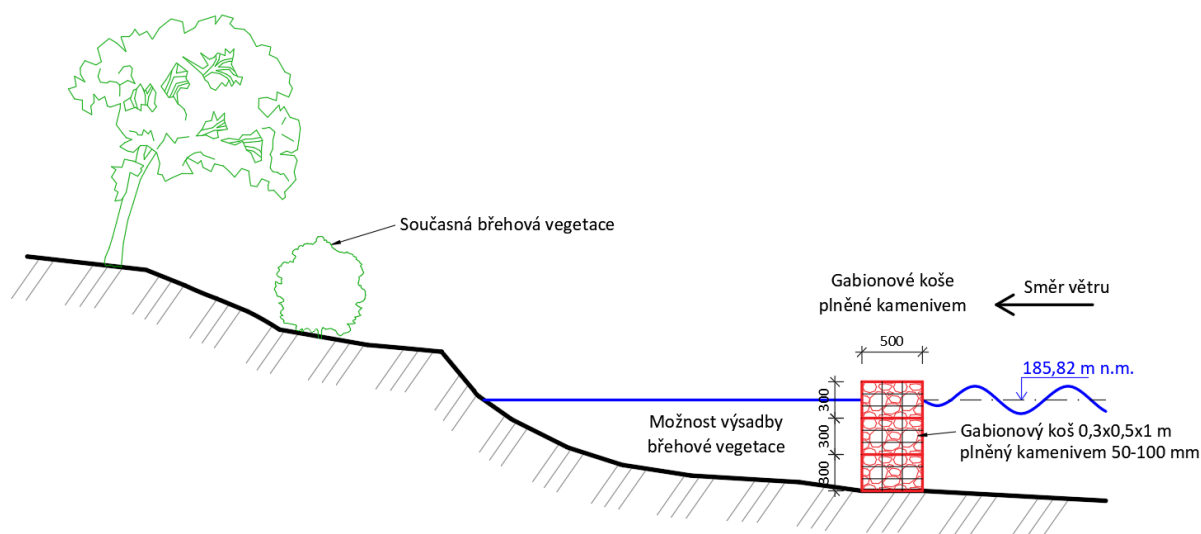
6 – Schematický návrh stabilizace – TYP B
